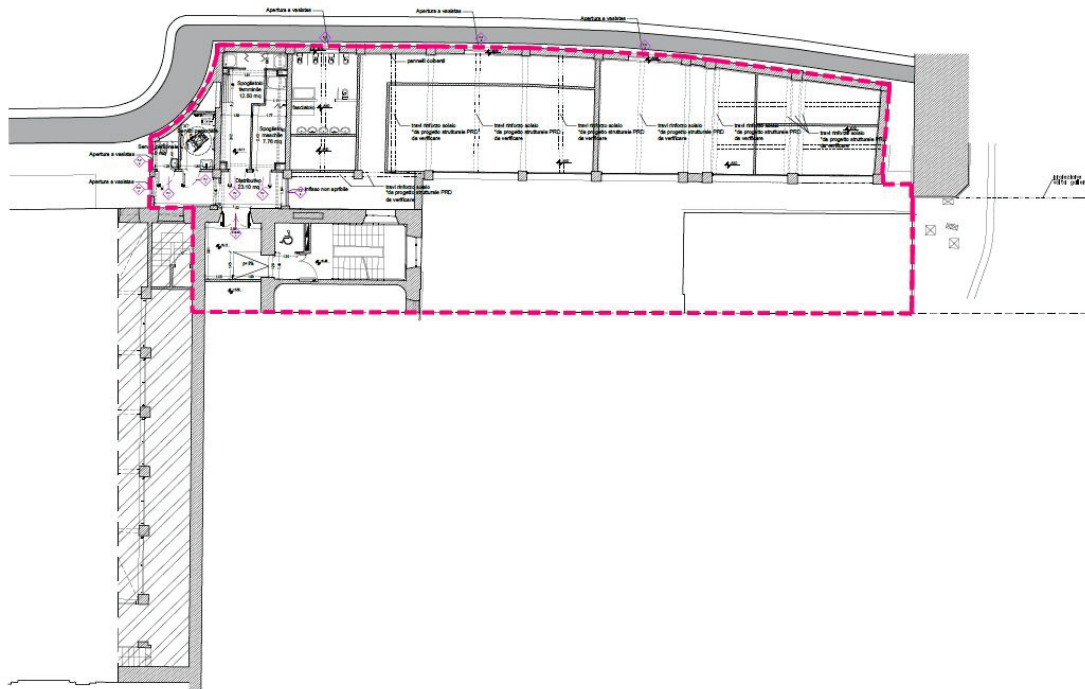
Planimetria del Piano Ammezzato con individuazione dell'area oggetto di intervento (perimetro magenta).
